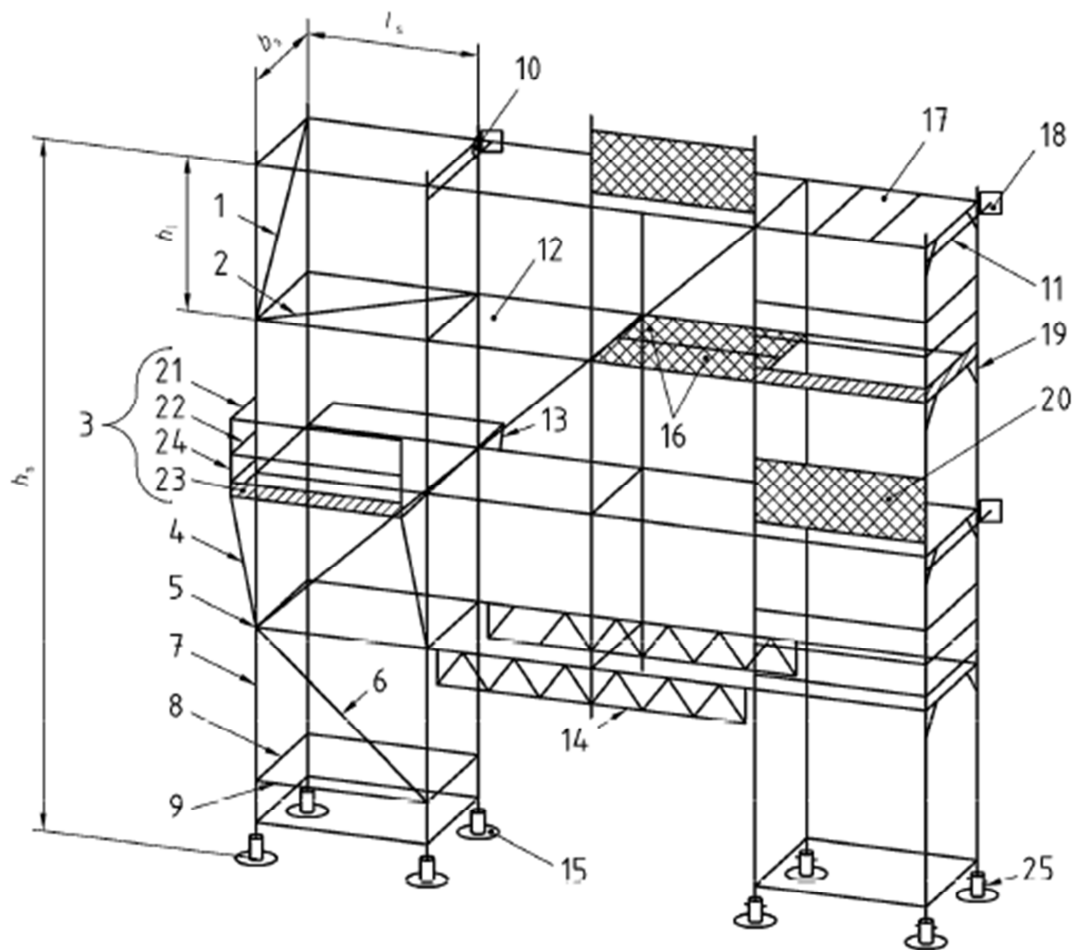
Detalle de una plataforma con escalera de andamio modular prefabricado.
